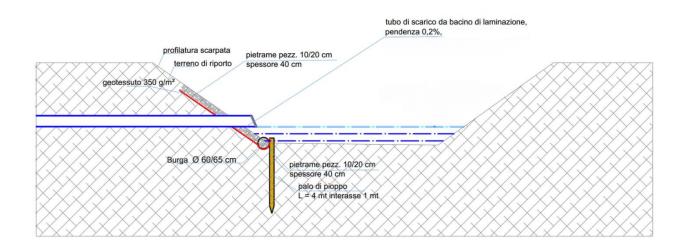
Sezione tipologica punto scarico e protezione spondale
